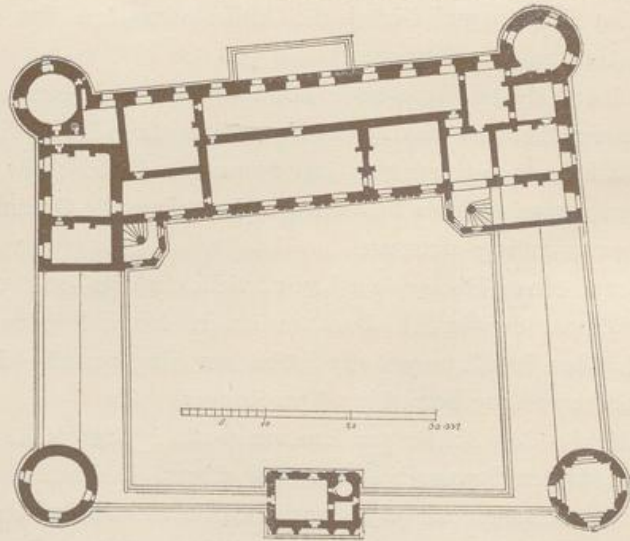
Château de Tanlay. Grundriss der 1. Etage.
